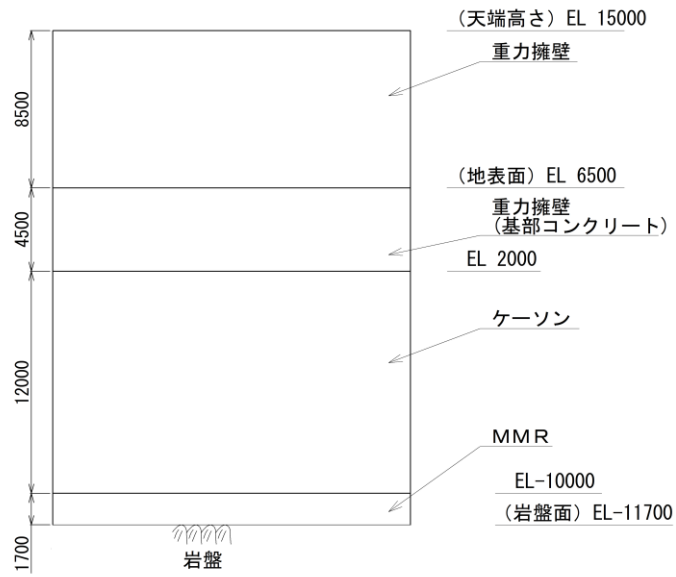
(1) 防波壁（波返重力擁壁）の構造図（ケーソン設置部）（正面図）
